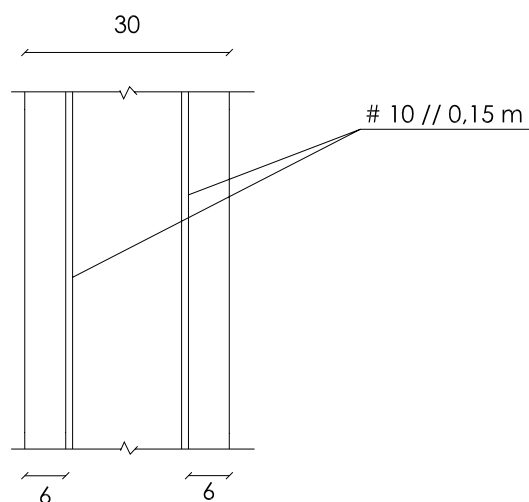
Secção transversal das paredes (medidas em cm)
